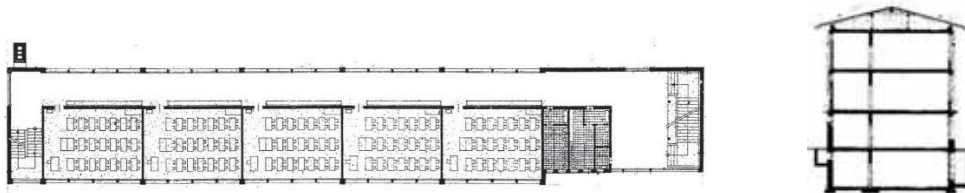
Schule Statthaltergut, Grundriss Obergeschoss und Schnitt des Haupttraktes
